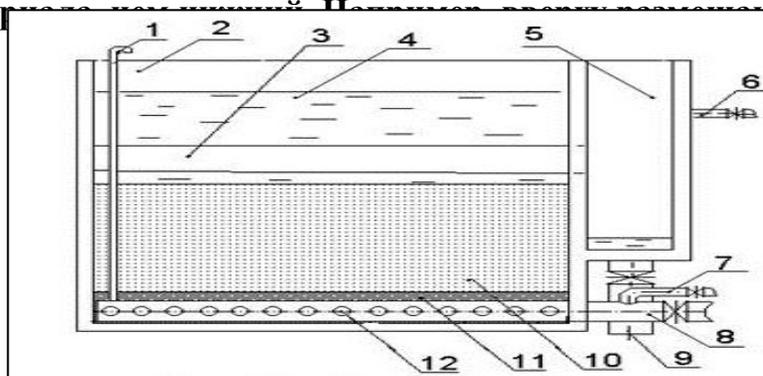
Схема безнапорного однослойного скорого фильтра с боковым каналом (продольный разрез):
